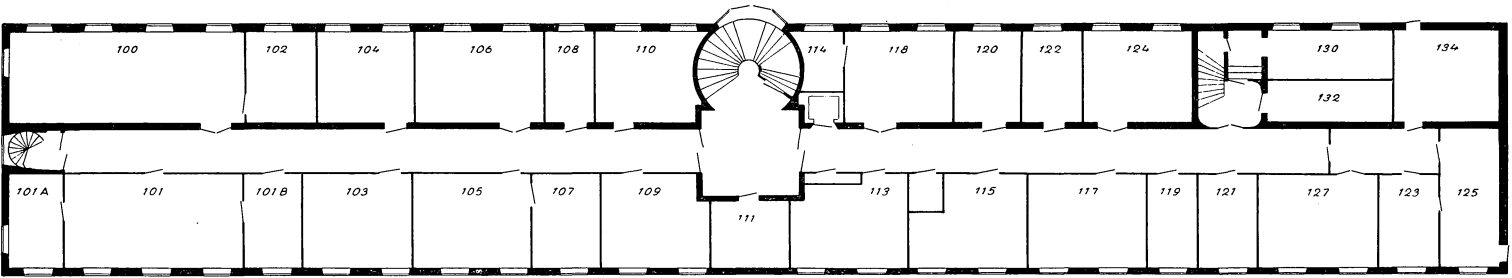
d. Nya byggnaden. Plan av källarvåningen.
